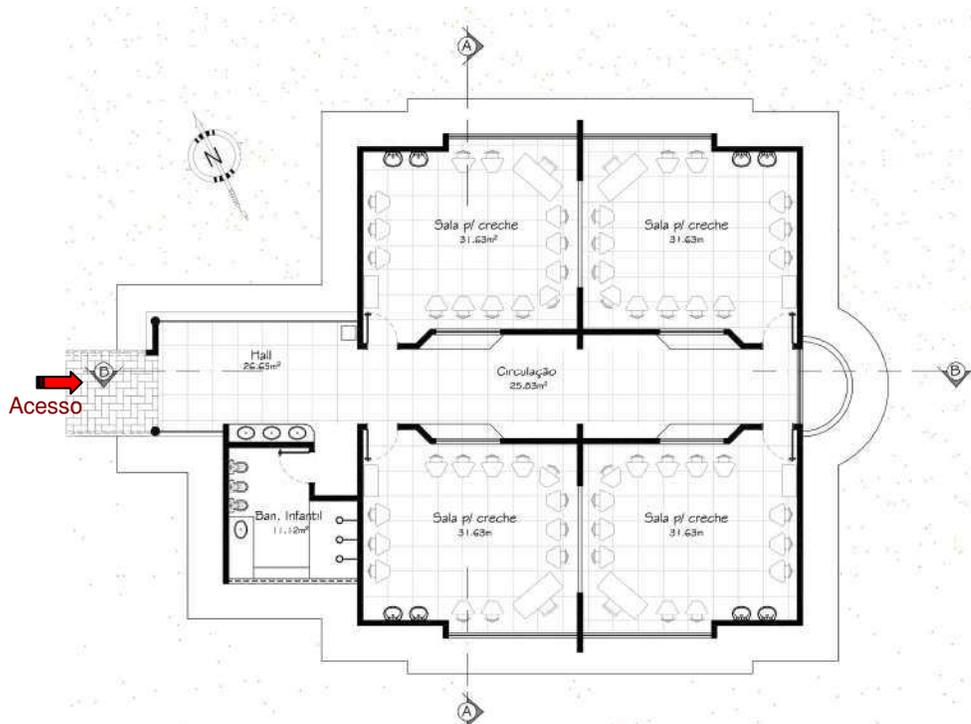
Prédio da Creche (Planta Baixa – Projeto Atual)
